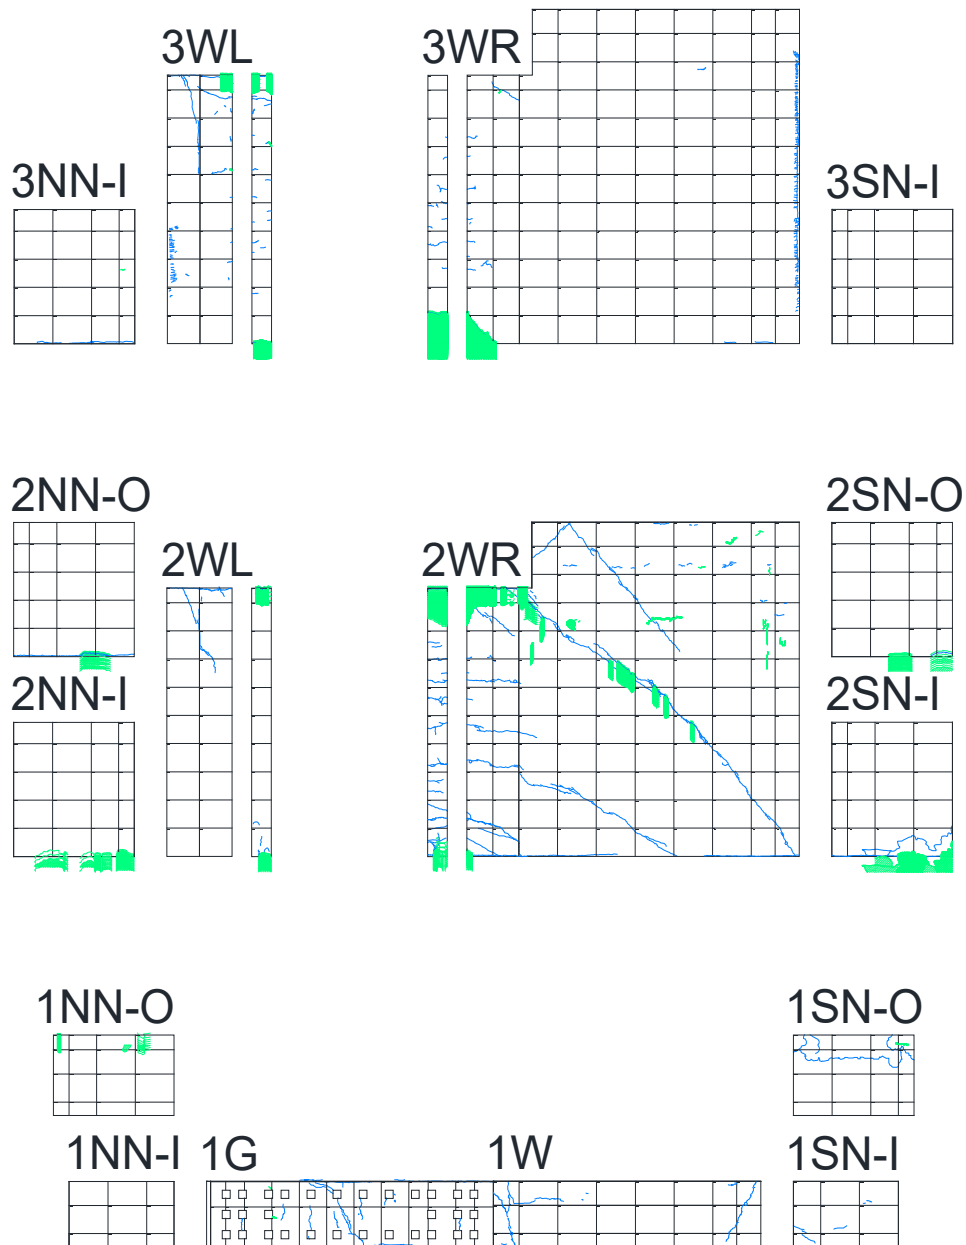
耐力壁および直交壁のひび割れ推移 サイクル:1/100 ①
